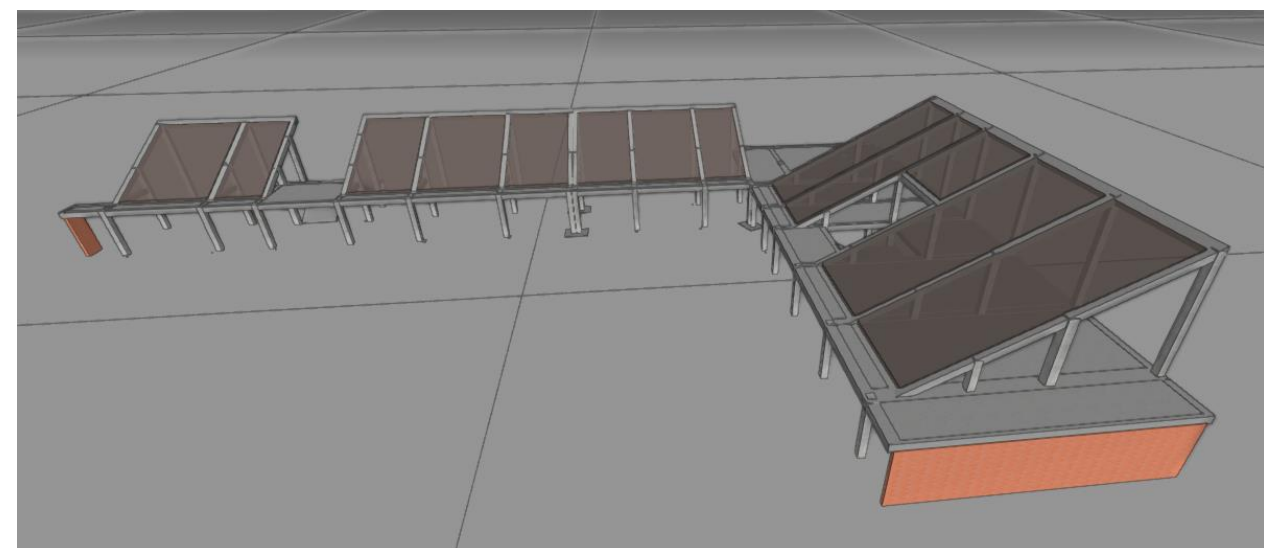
Esquema tridimensional de la estructura interior de hormigón armado
